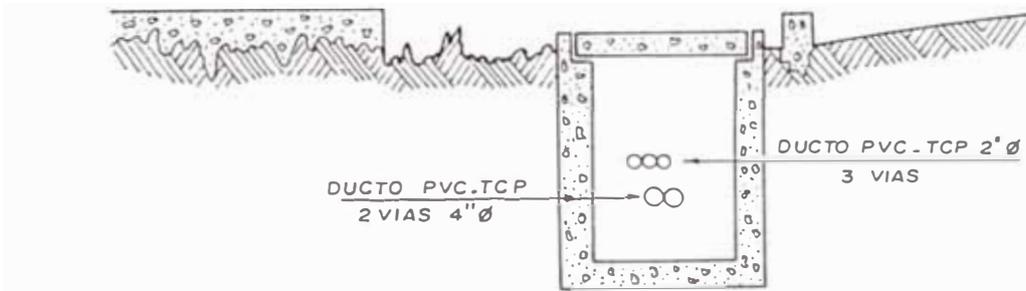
DETALLE DE CONSTRUCCION DE CANALIZACION -
